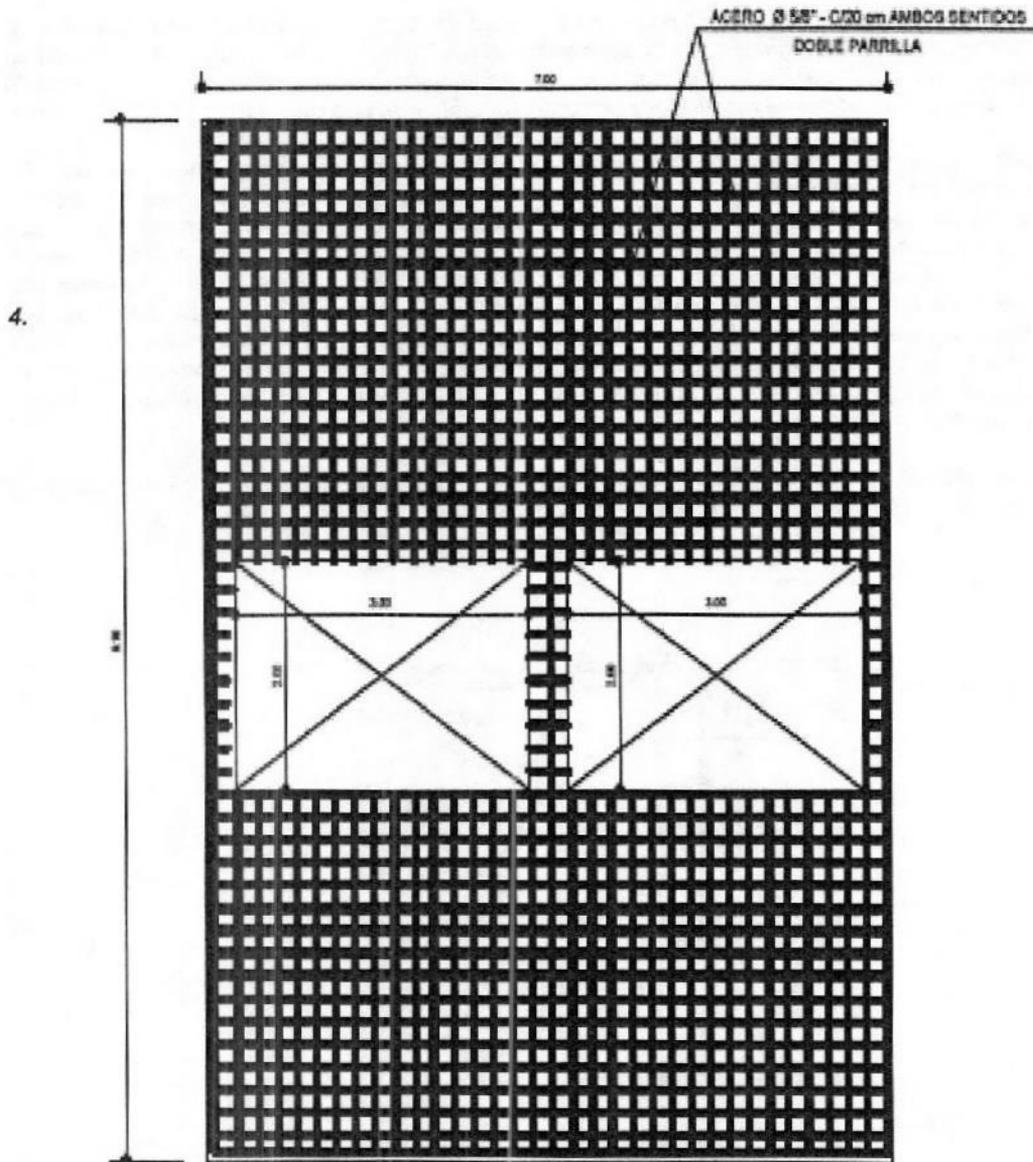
Despiece muro frontal pozo de succión. Fuente: Plano estructural solicitante
